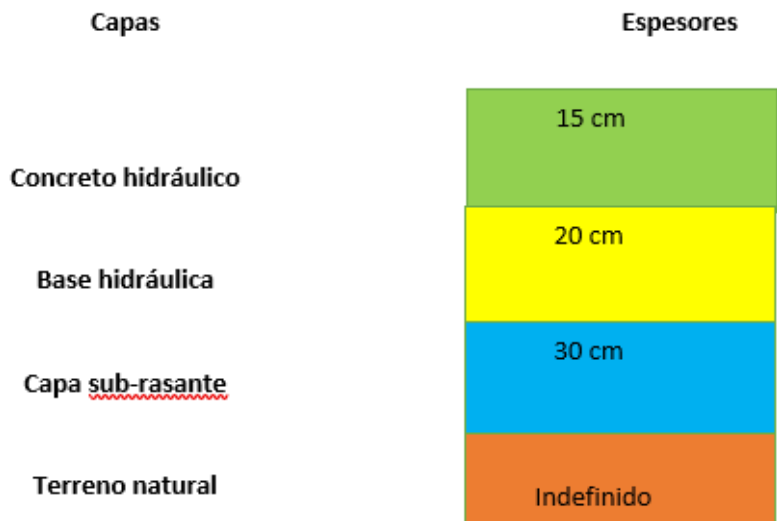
Sección de proyecto a construir para los dos cuerpos.
